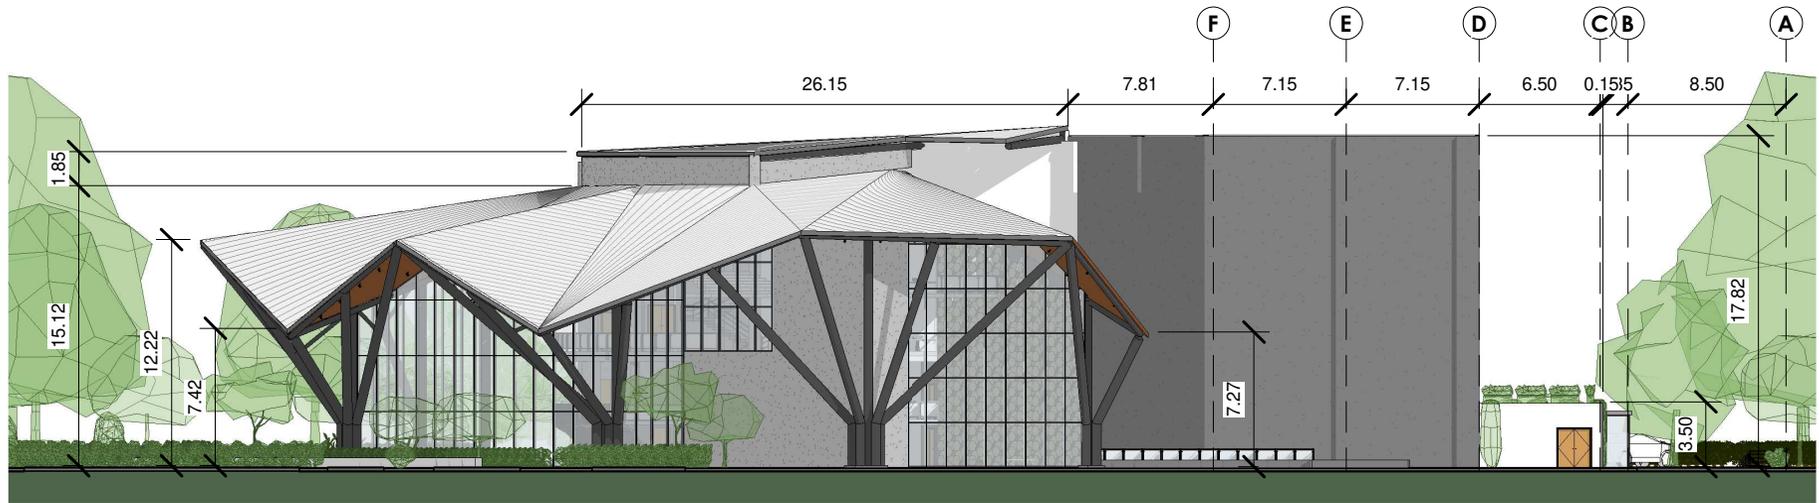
Collage elevación y perspectivas fachadas laterales.
